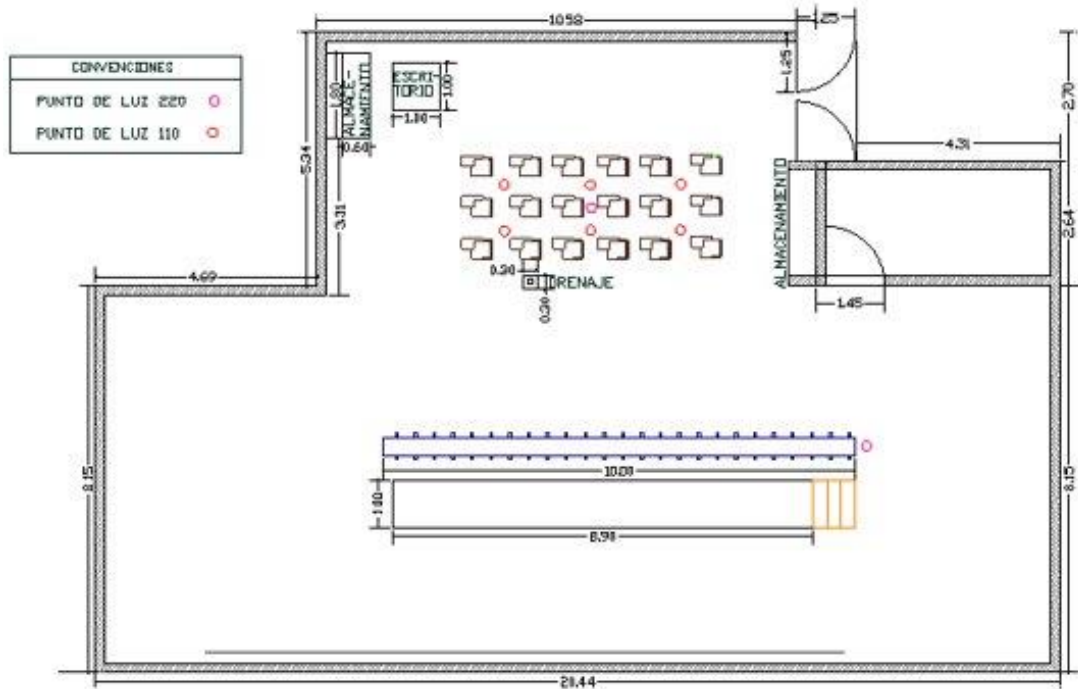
Plano con distribución de equipos propuesta dos de equipamiento para el nuevo laboratorio de hidráulica de la UIS.
